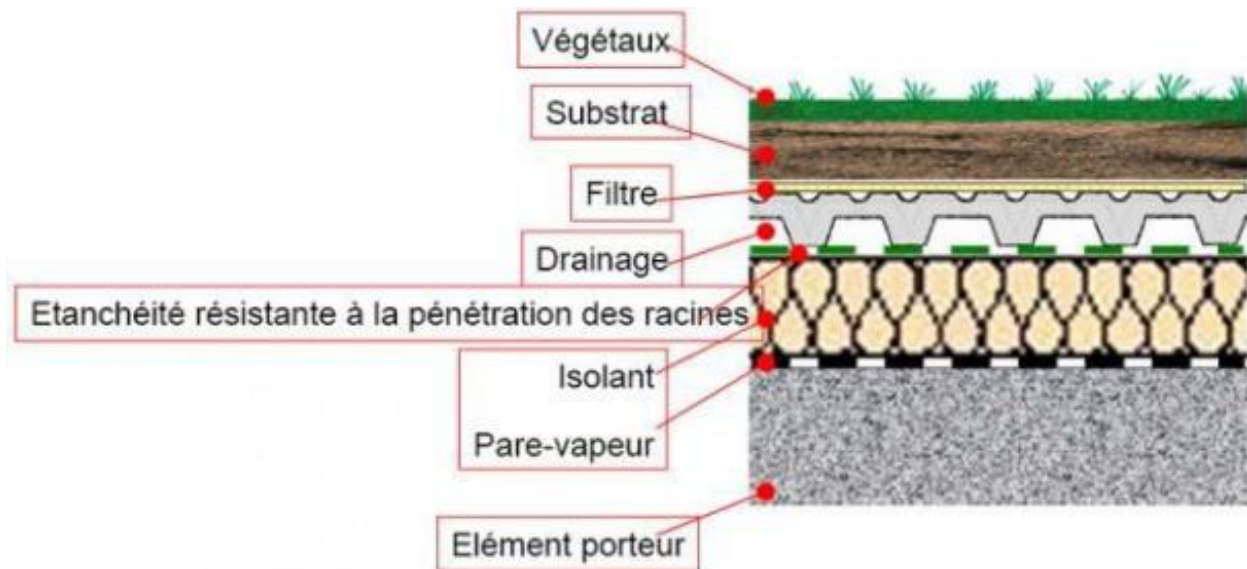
PLANCHER TOITURE VEGETALISER SOURCE : SITE WEB TOIT VEGETAL .FR
